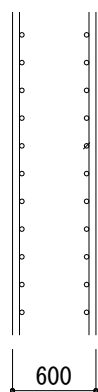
耐震壁の配筋図 (B1階, 4通り, B~C通り間) (単位: mm)
